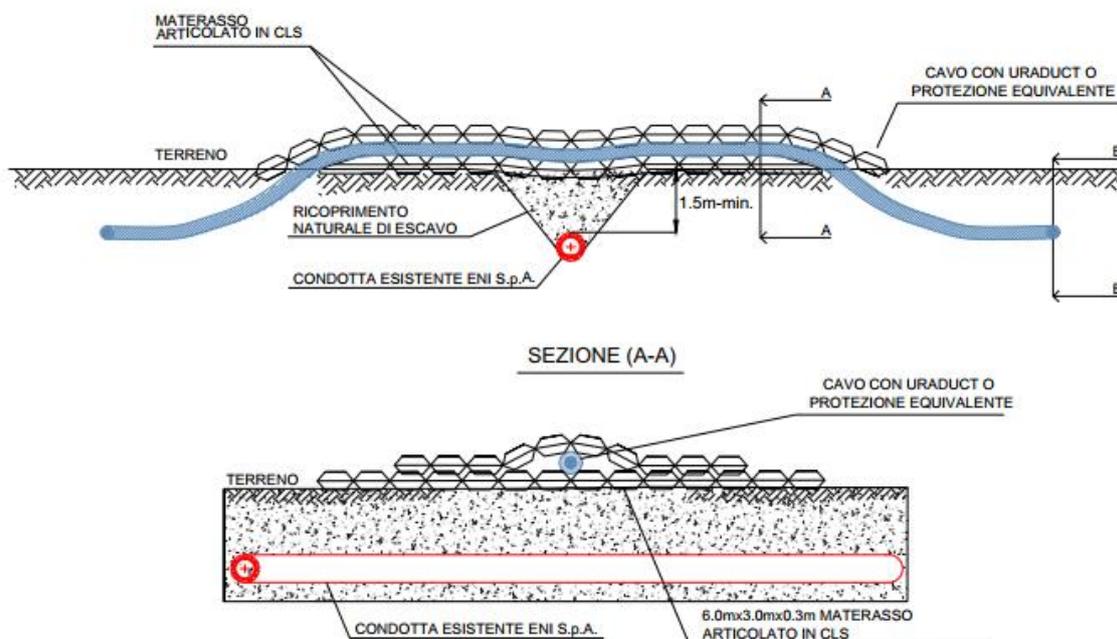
Concrete Mattresses per attraversamenti di condotte interrato.
